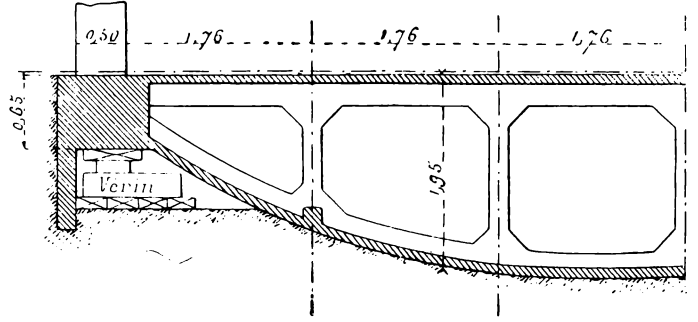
Demi-coupe du radier en béton armé, montrant la disposition d'un vérin
